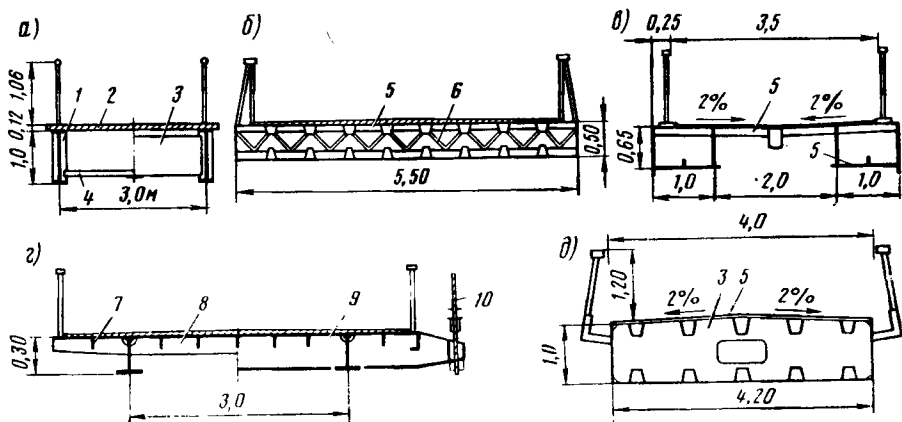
Поперечные сечения вантовых металлических пешеходных мостов: 1 — главная балка; 2 — железобетонная плита; 3 — диафрагма; 4 — распорка; 5 — ортотропная плита с покрытием; 6 — решетчатые связи с шагом 2,4 м; 7 — продольное ребро жесткости сечением 120×8 мм; 8 — поперечная балка сечением 250×8 мм с шагом 2,7 м; 9 — поперечная балка сечением 300×8 мм с выступом для закрепления вант; 10 — вант
